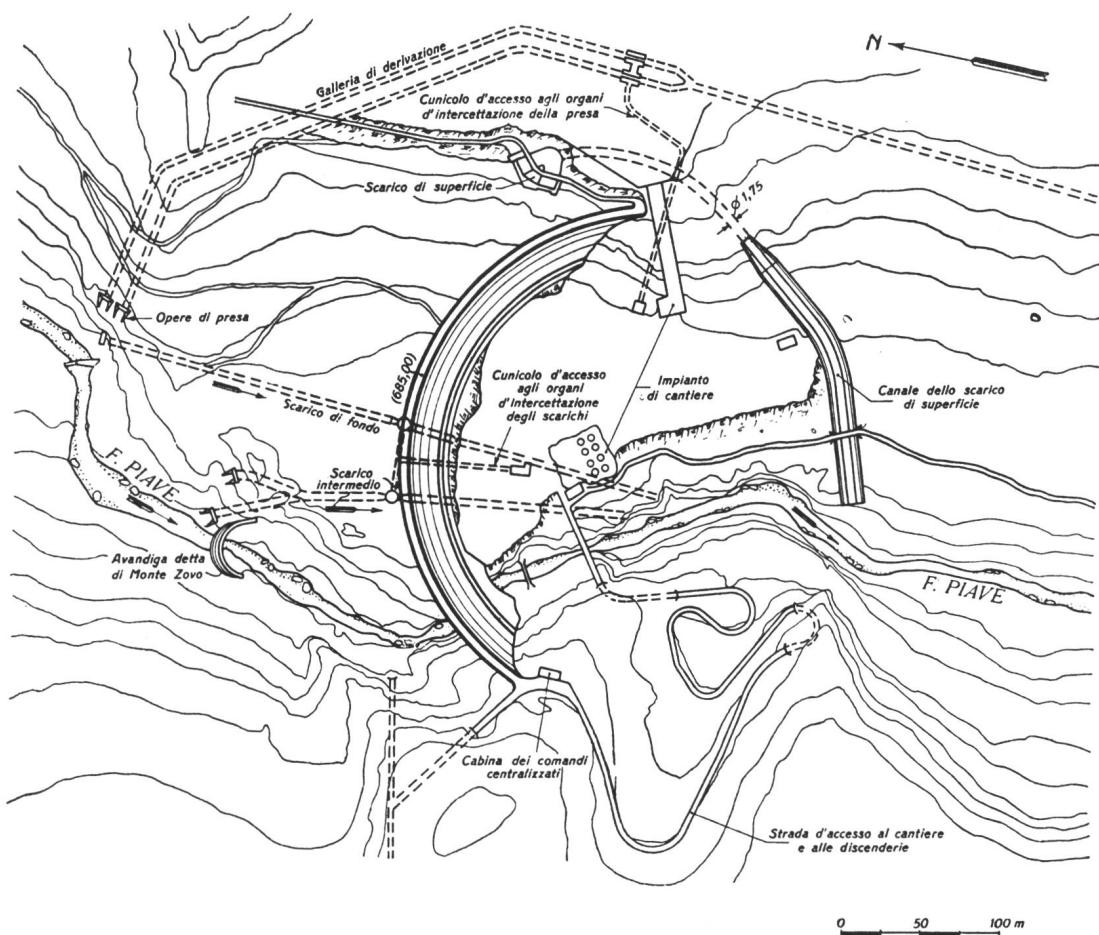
Bogengewichts-Staumauer Pieve di Cadore, Lageplan 1 : 5000
